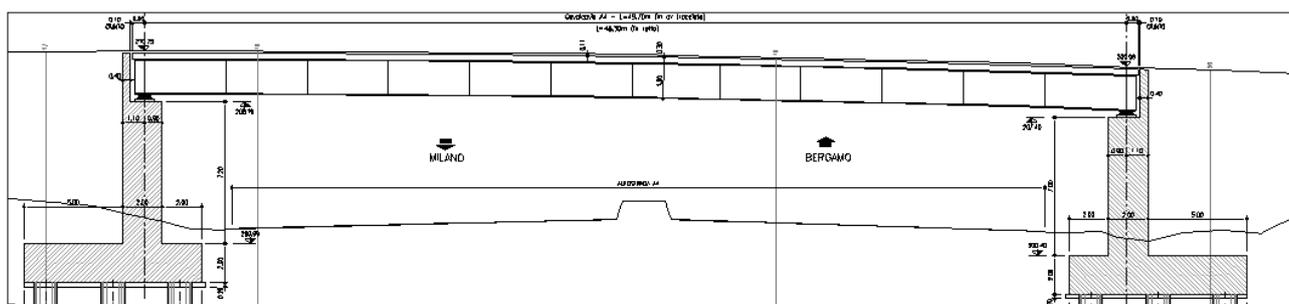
prospetto del nuovo cavalcavia autostradale
